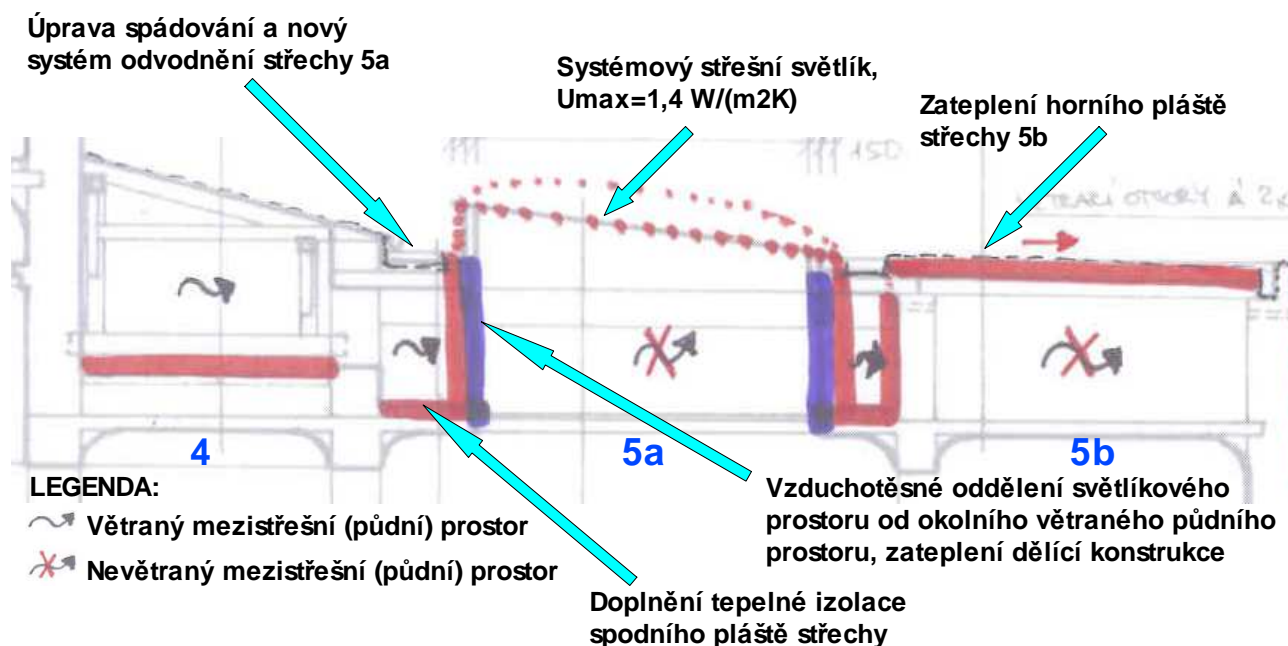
Princip opravy střechy 5a a 5b – Varianta 1
